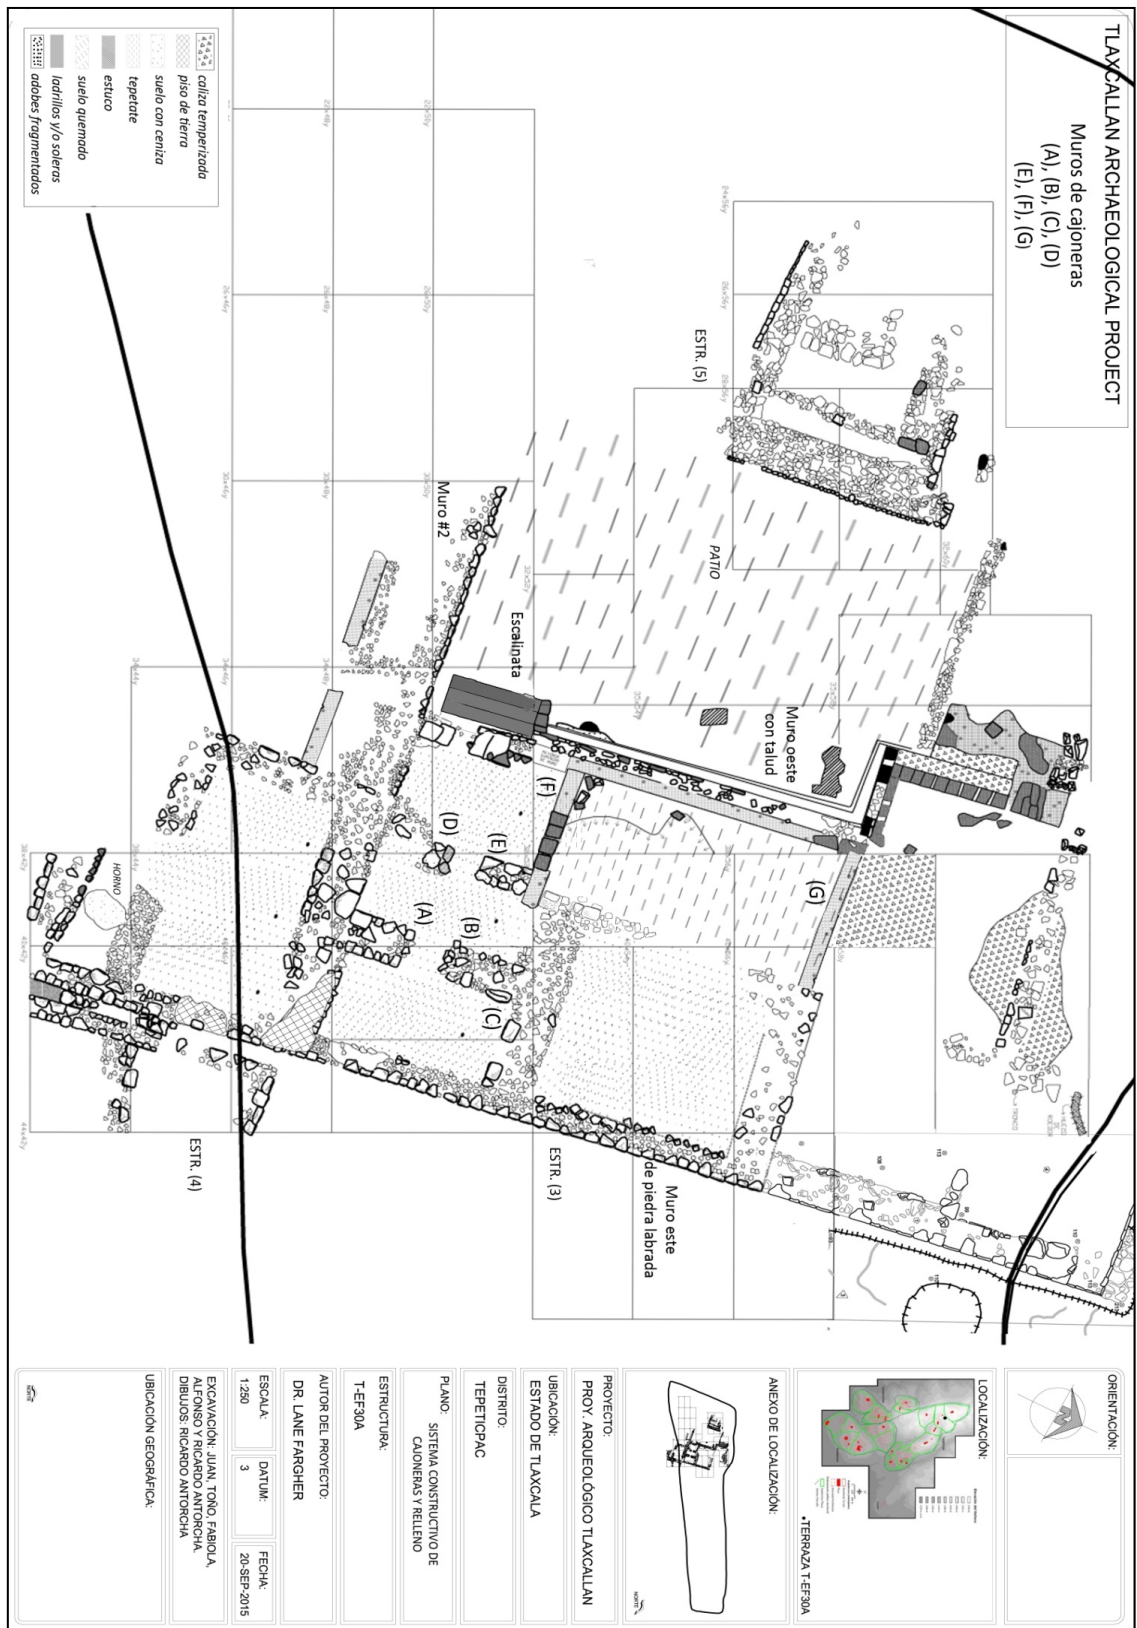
Planta arquitectónica de la estructura (3/1°). Sistema de cajonera (A, B, C, D, E, F, y G) empleado para la cimentación de la última etapa constructiva.
